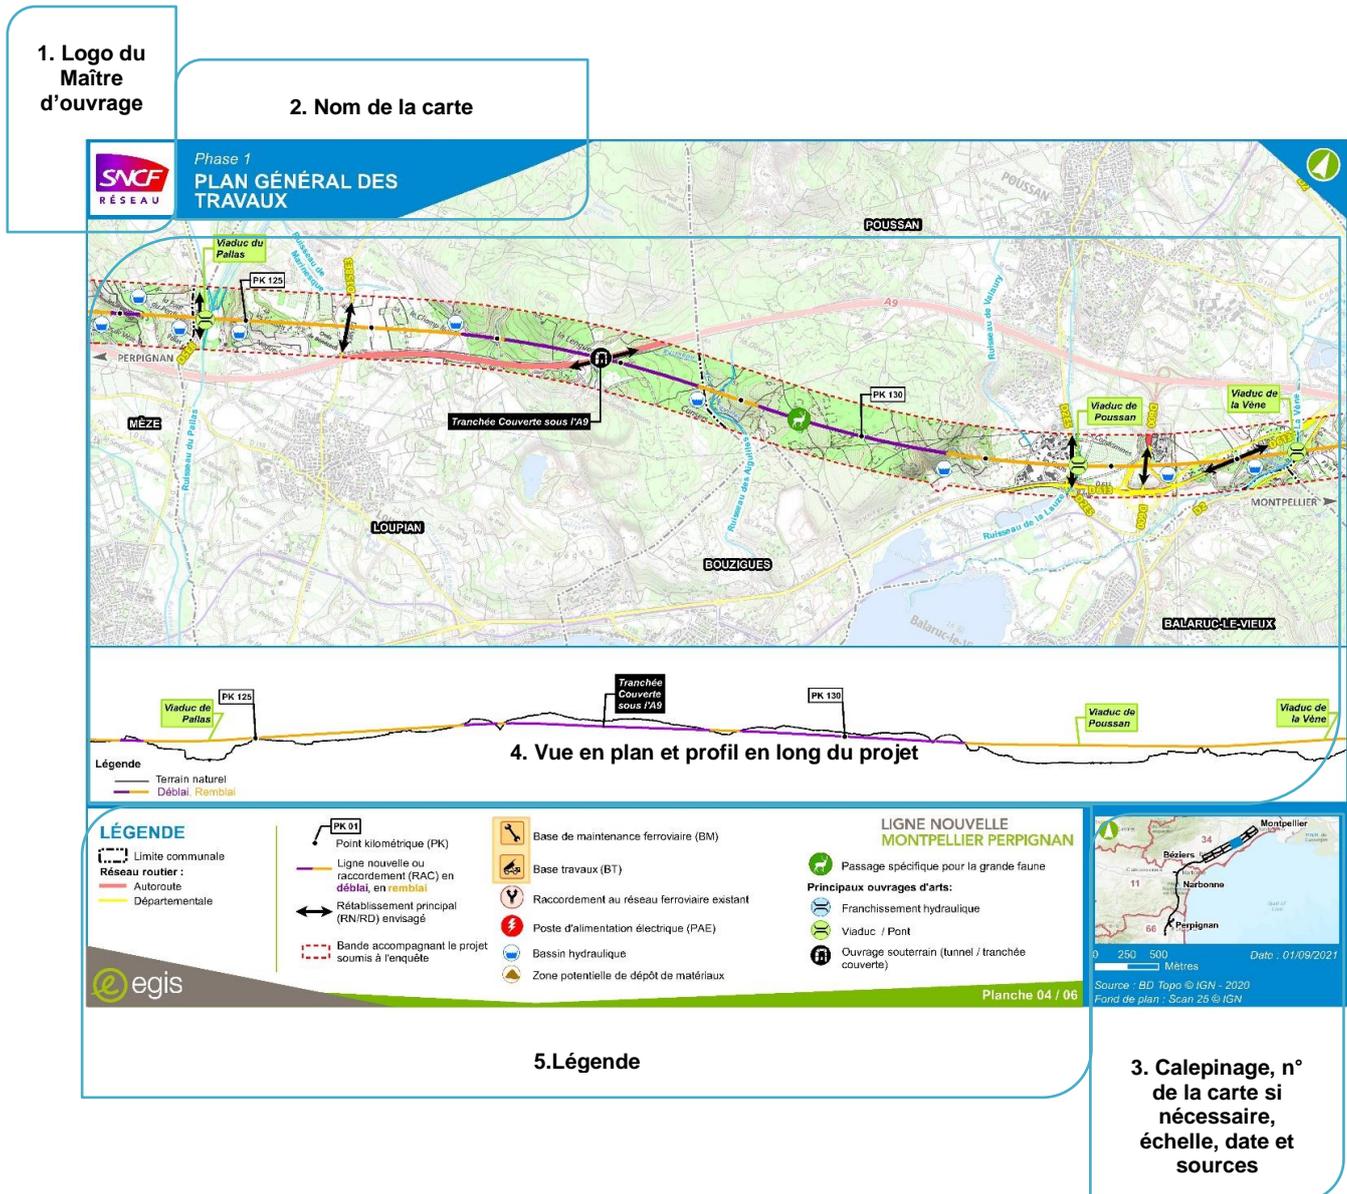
Extrait de la carte du plan général des travaux – Pièce E du présent dossier
